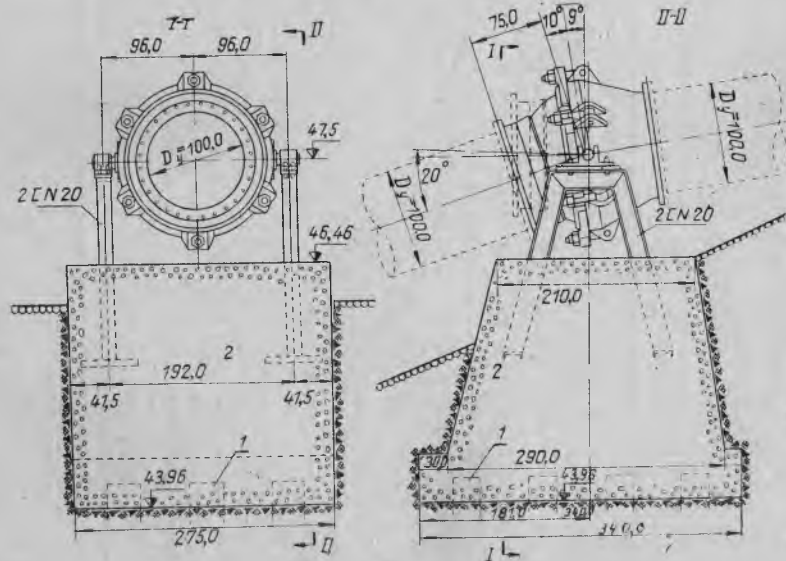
Анкерная опора на прямом участке стального трубопровода:
